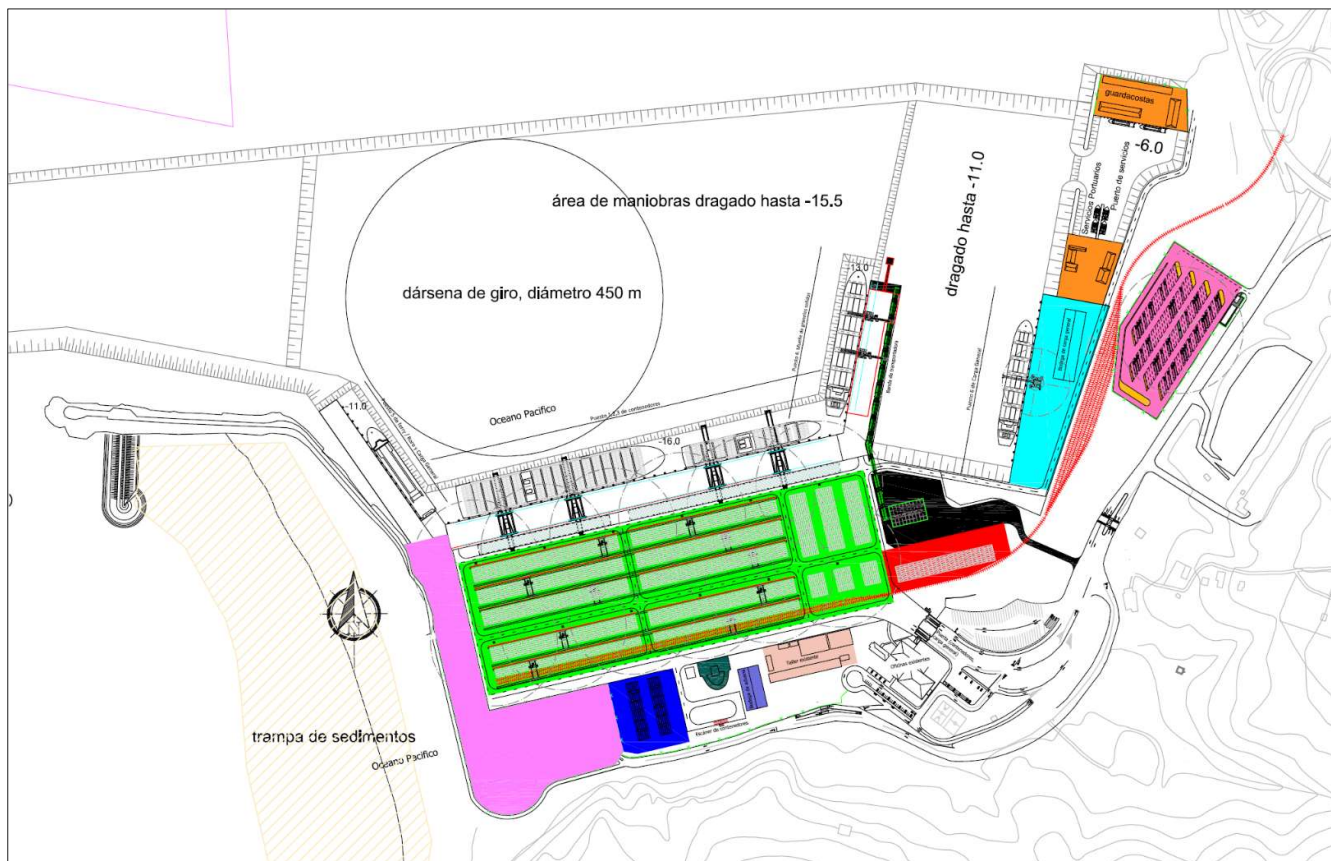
Plan Maestro de puerto Caldera Fase C
